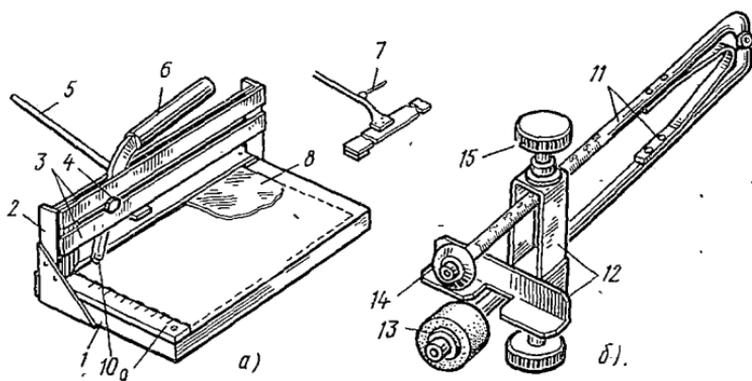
Рычажный (а) и роликовый (б) плиткорезы для керамической плитки:
